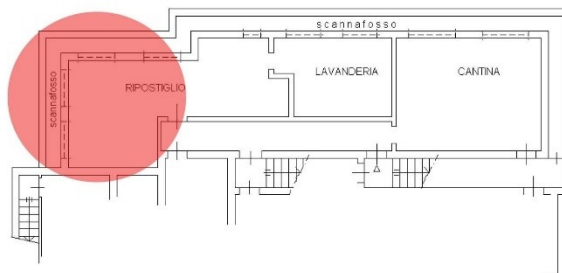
Stralcio plan. Catastale subalterno 5
